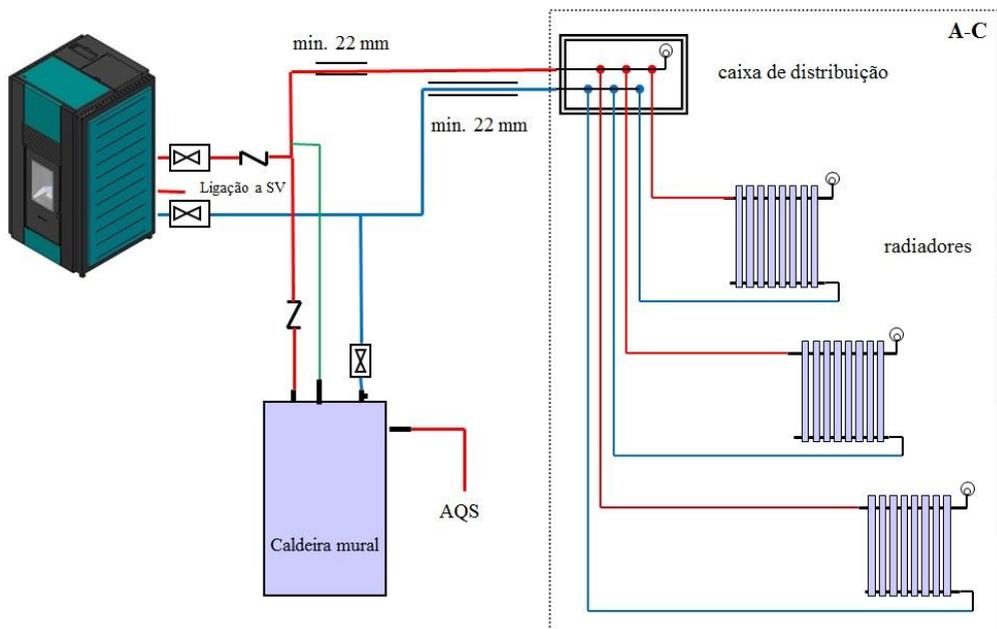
Esquema de instalação para aquecimento central a Pellets com apoio de caldeira mural.
